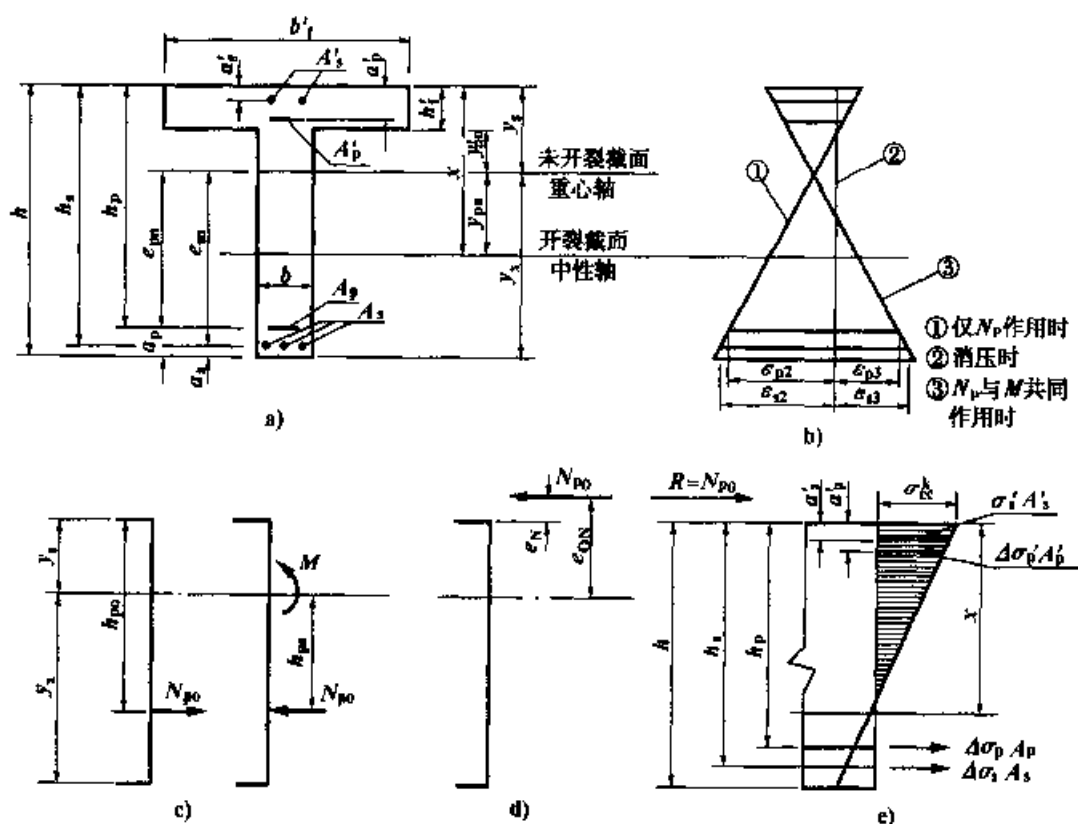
开裂后部分预应力混凝土 B 类构件应力计算图式
